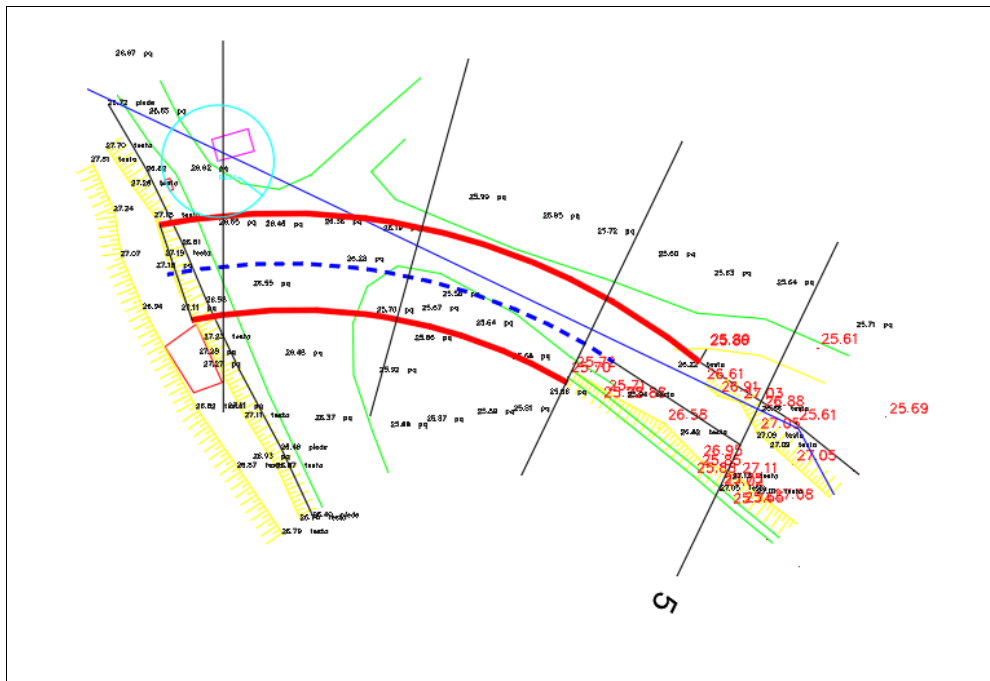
Planimetria di variante argine Comune di Capena, sez.1-5
